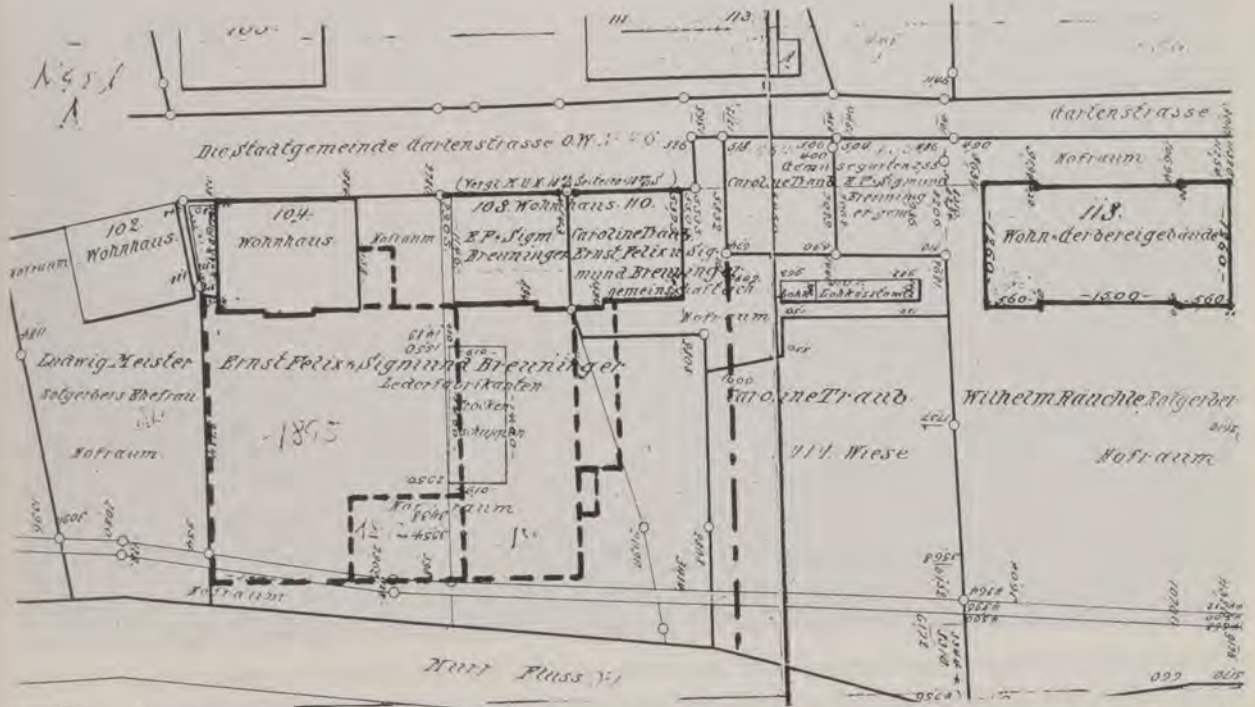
Lageplan von Gartenstraße 102–118 mit Besitzverhältnissen und Gebäuden im Jahr 1891.
